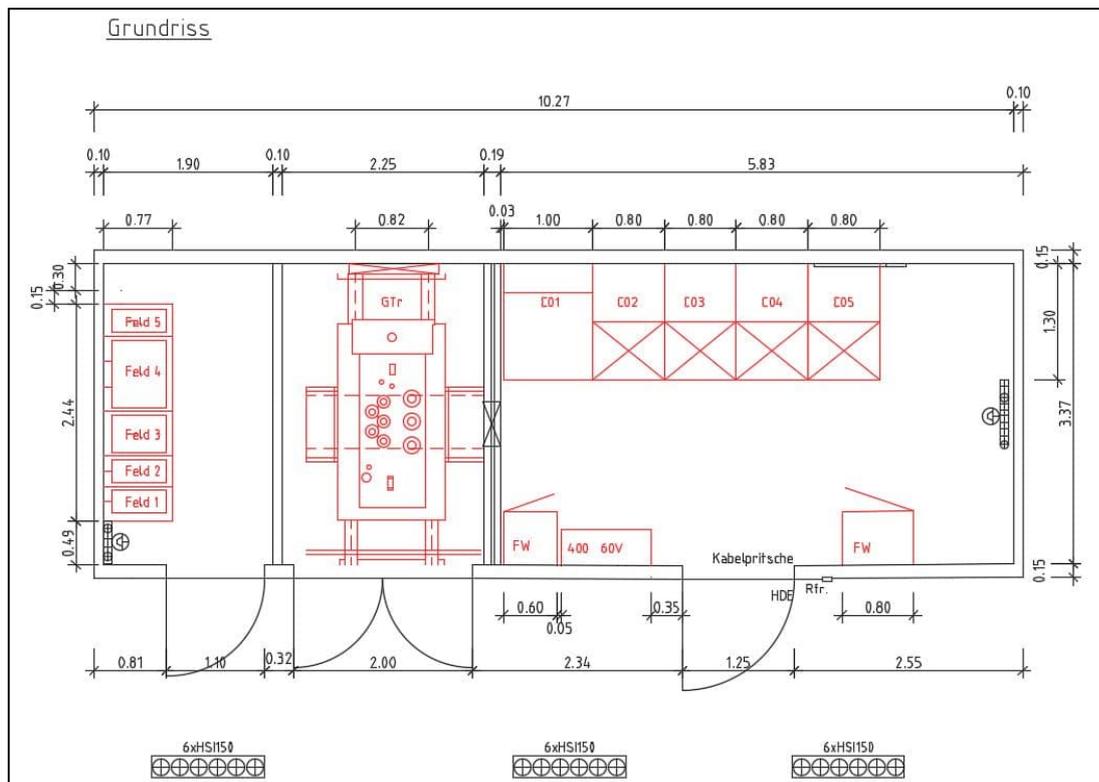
Grundriss G UW Heidelberger Straße 230
